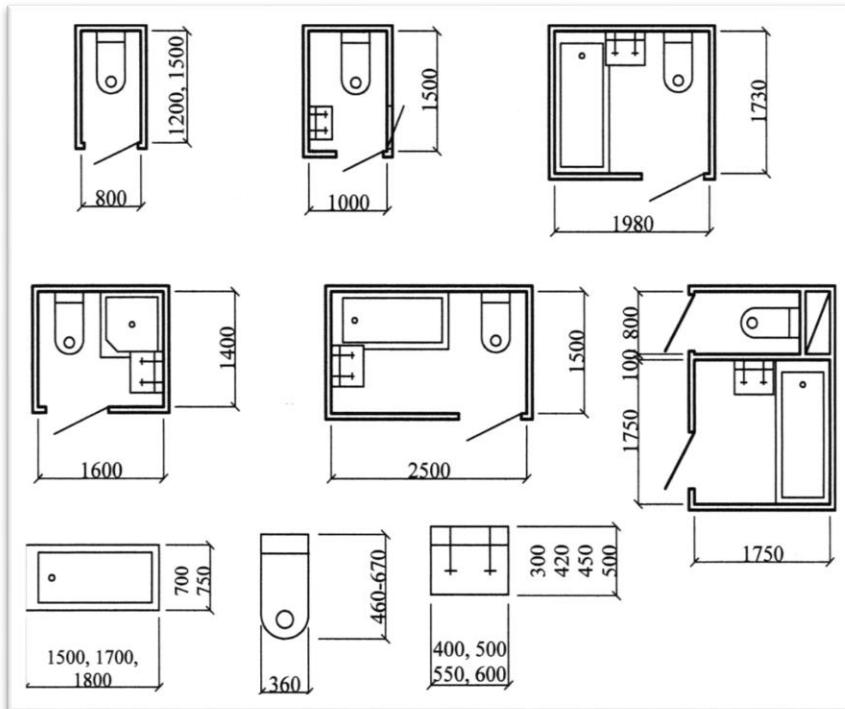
Планировочные схемы санузлов и размеры санитарного оборудования
